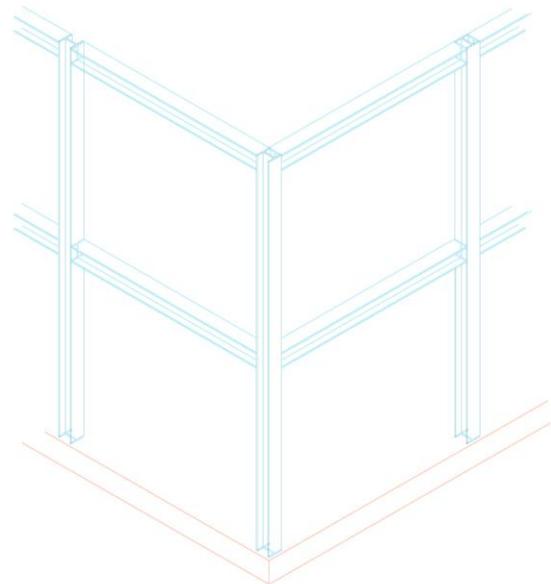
Axonometría constructiva sistema viga-pilar de acero (Dibujo original)
